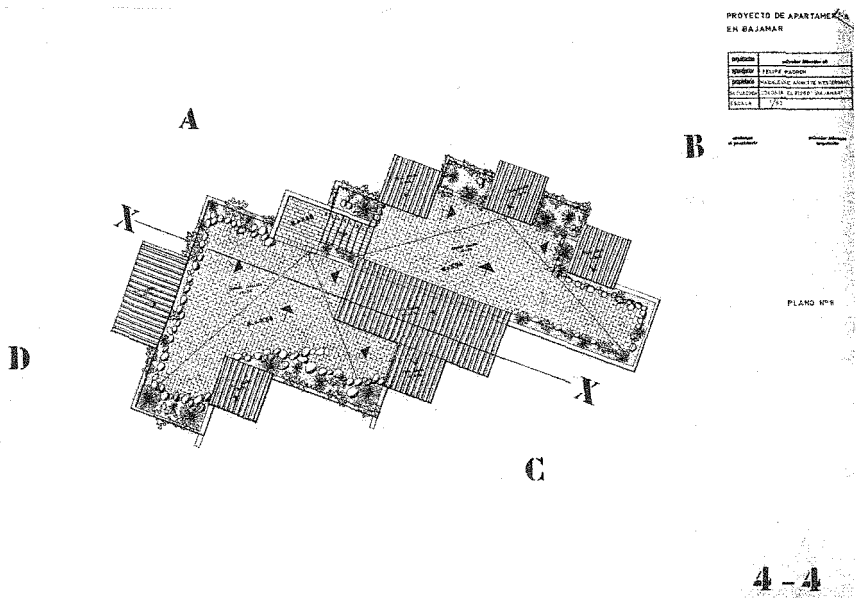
Salvador Fábregas, Plano n.º 8. Cubierta. Proyecto de apartamentos en Bajamar, Tenerife, 1963 (Archivo Fábregas).
